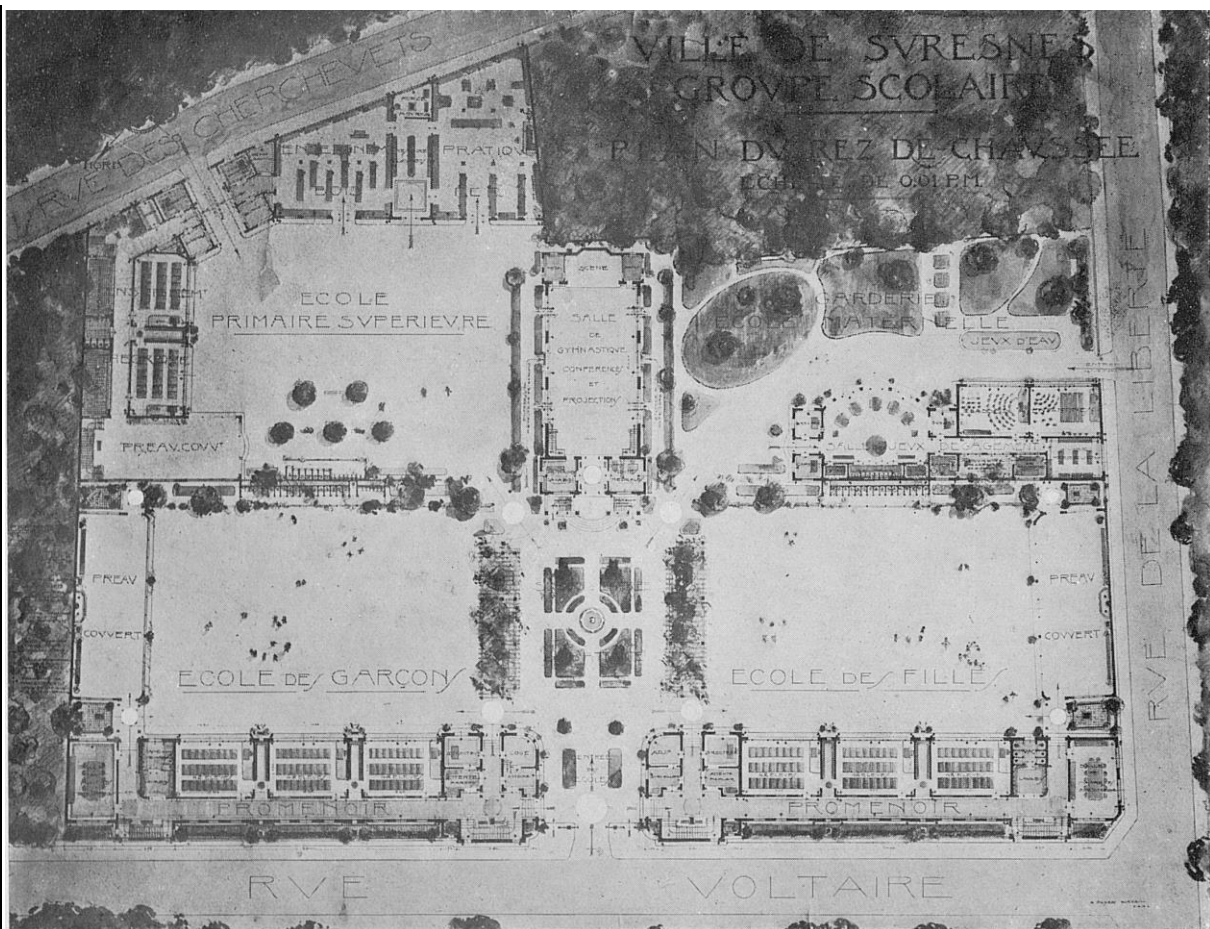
Groupe scolaire de la rue Voltaire, Suresnes, Maurice Payret-Dortail, architecte, 1924. Plan du rez-de-chaussée du groupe scolaire. AM de Suresnes série M.
